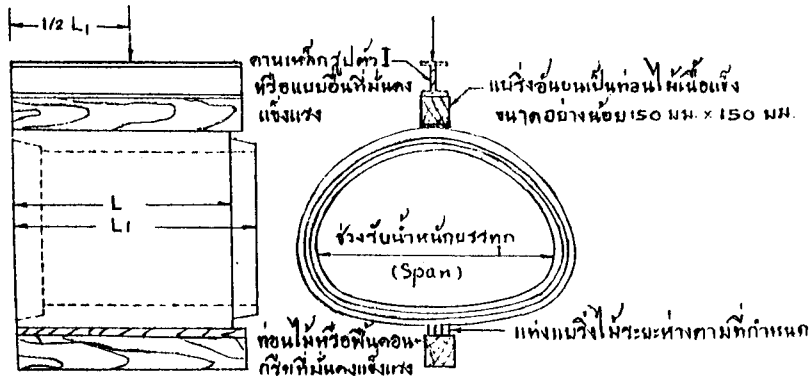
การทดลองท่อแบบปากลิ้นรางโดยวิธี THREE-EDGE BEARINGS
